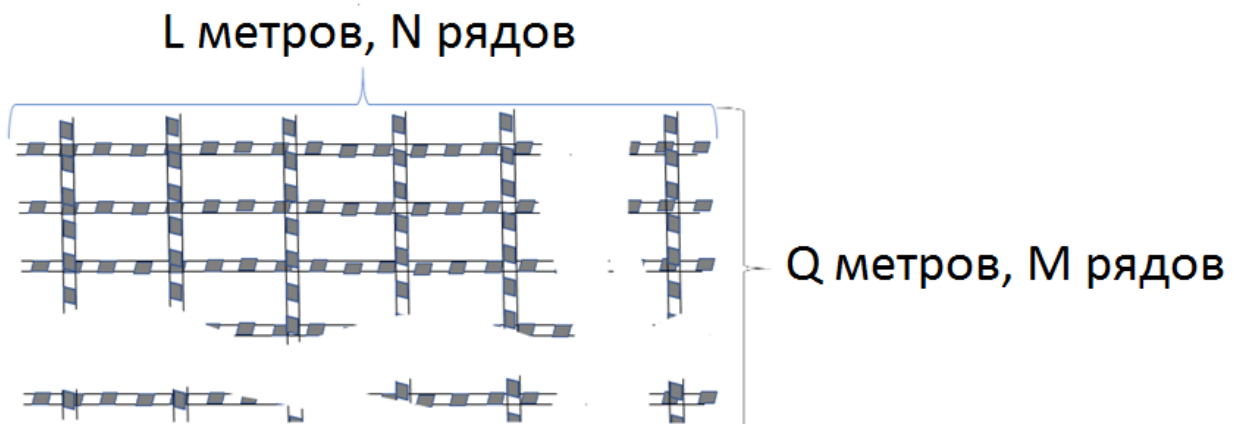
Типовая схема армирования перекрытия (составлено авторами)
